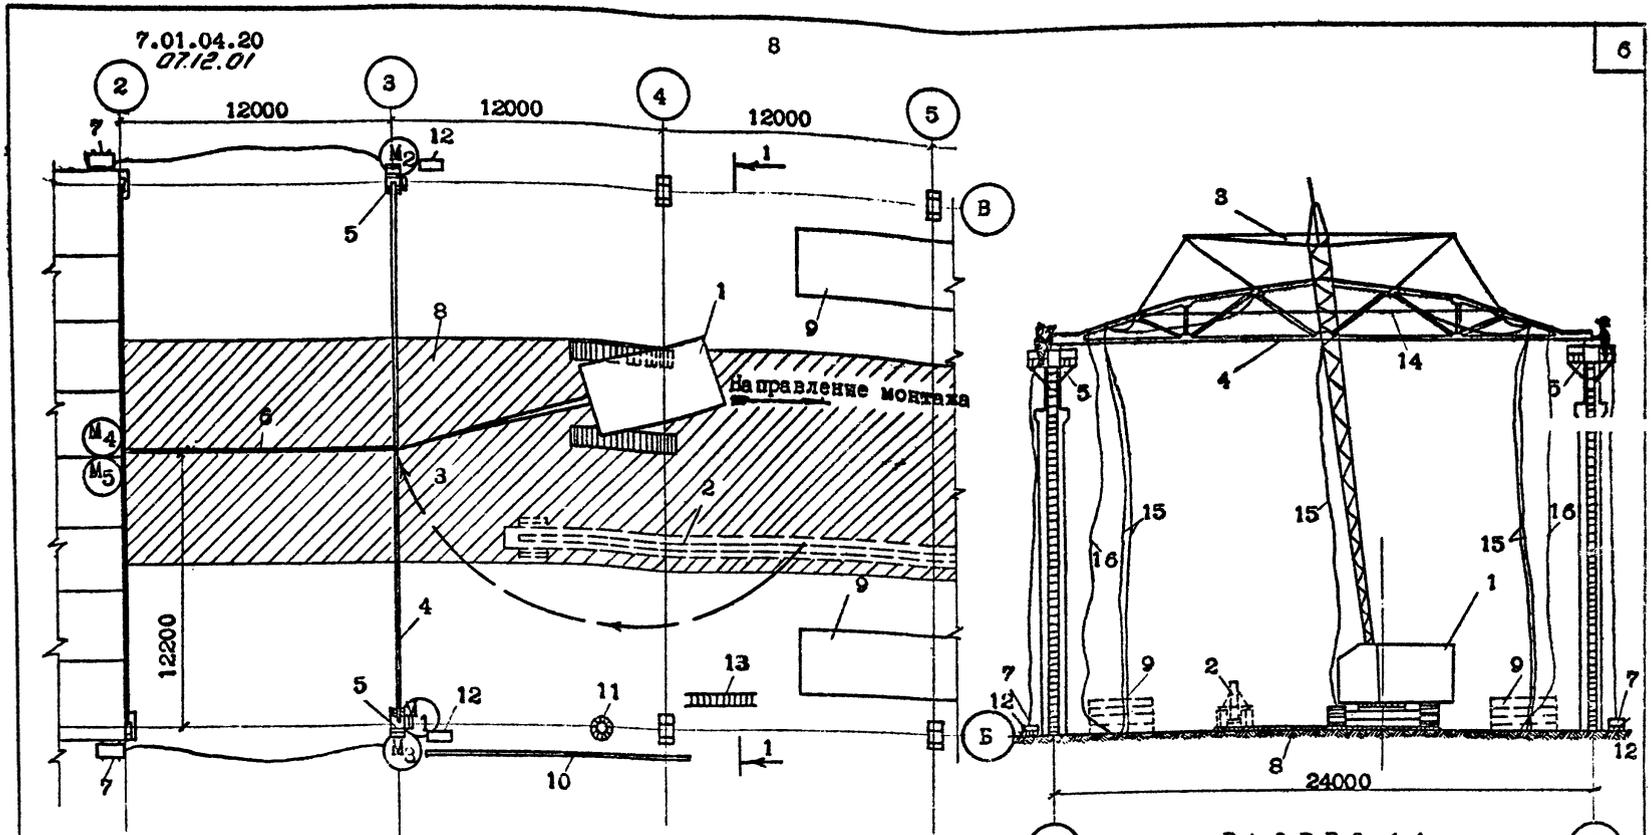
Схема организации рабочего места при монтаже стропильных ферм.
